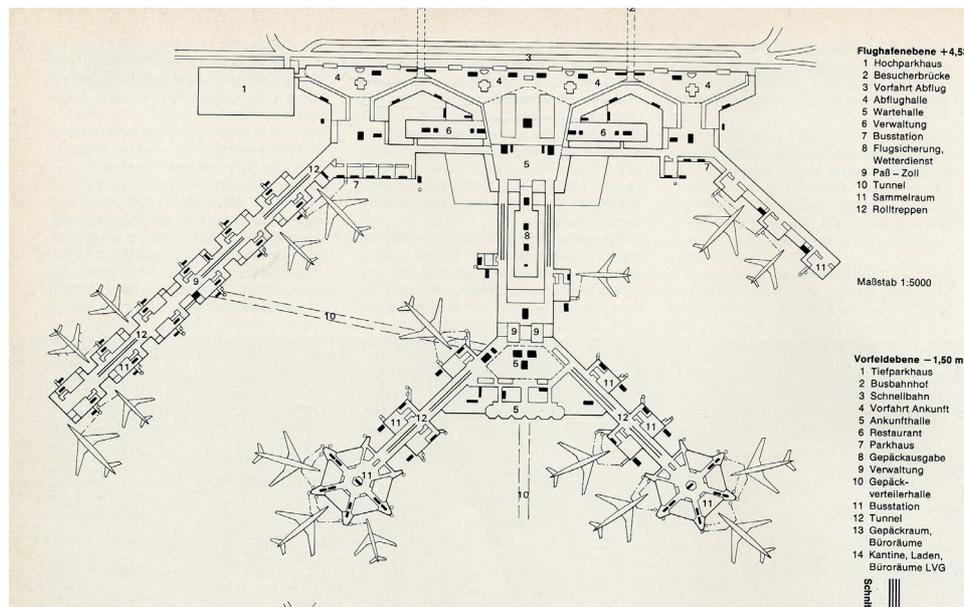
Der Lageplan des Frankfurter Flughafens
